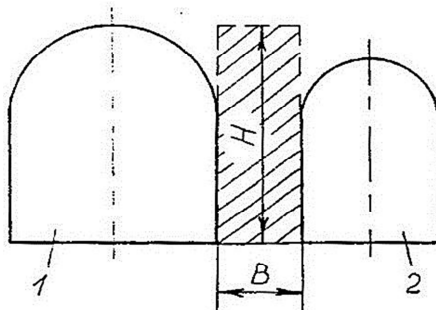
Охрана горизонтальной выработки разгружающей выработкой:
